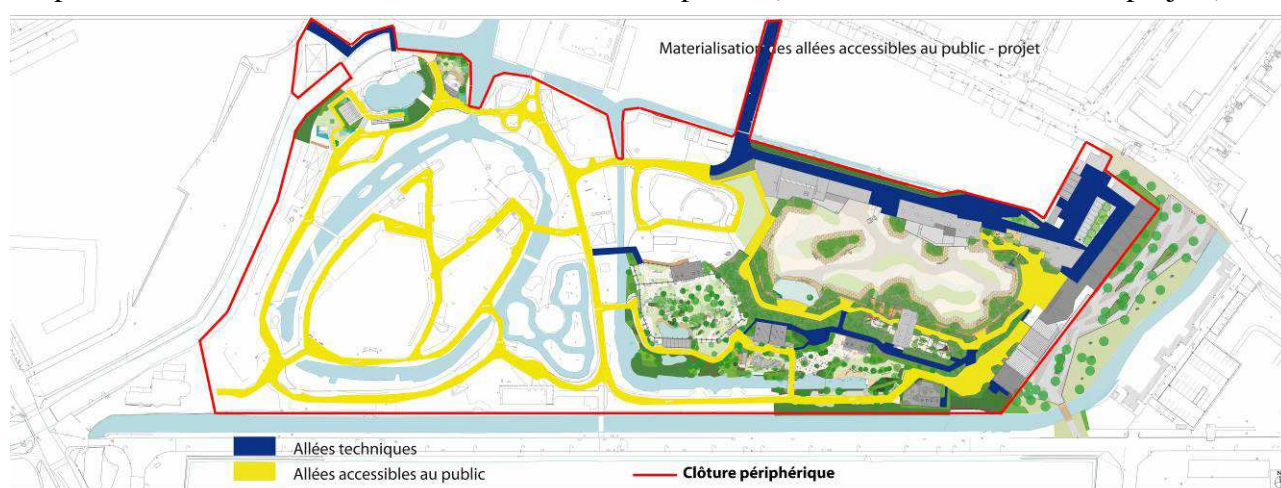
Plan du parc « état projeté » avec les allées accessibles au public.
